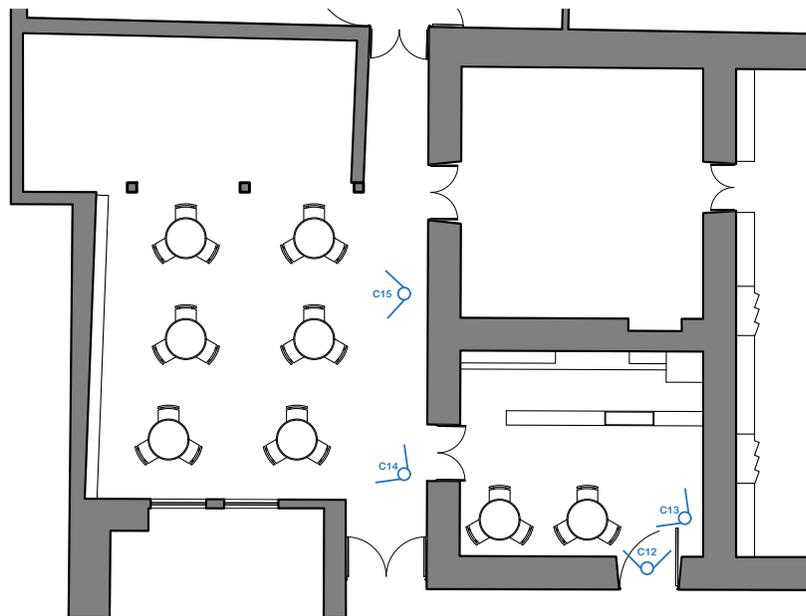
Planta Propuesta Cafetería (E1) - Exterior
